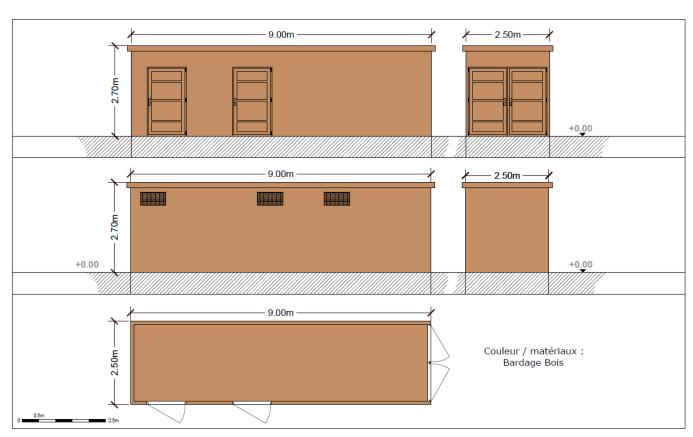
Plan des façades / Plan de coupe du PDL et local technique (Source : SOLVEO)
